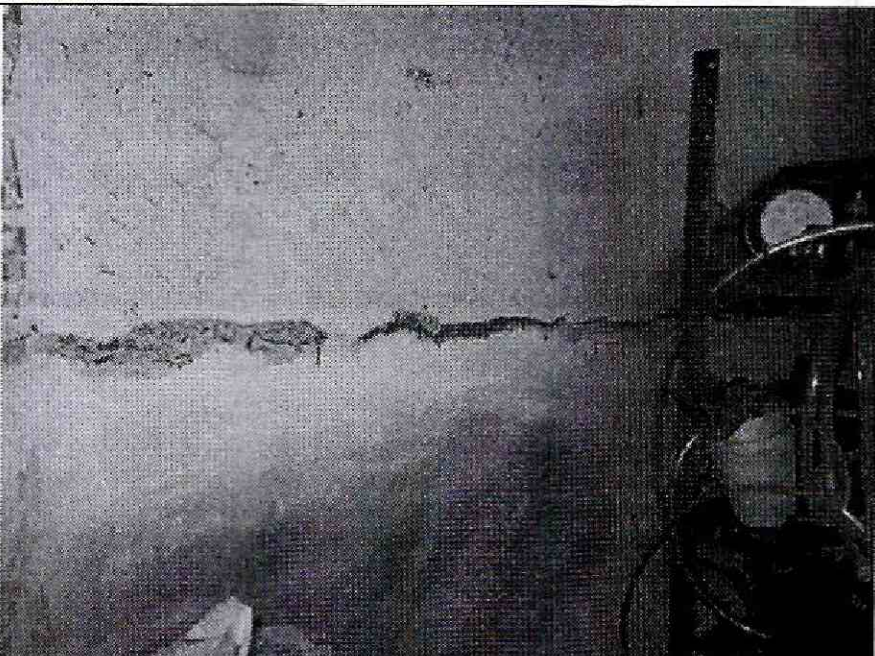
Fisura horizontal en muro del costado sur.
